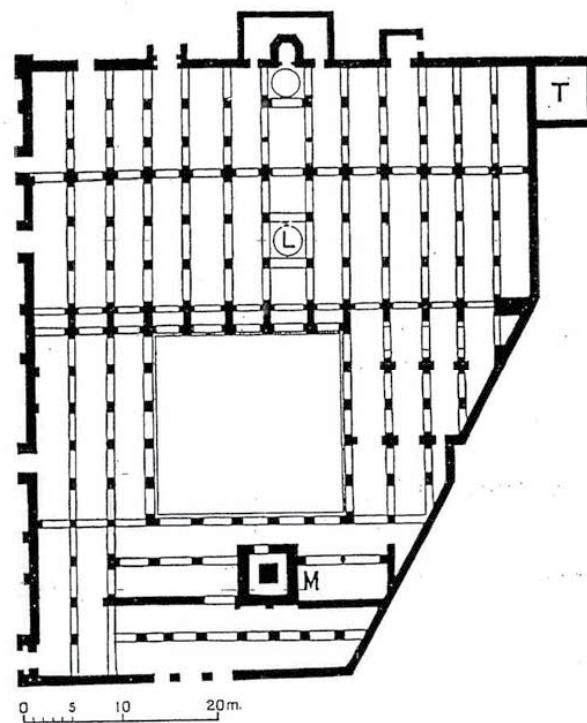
جامع ندرومة، مسقط أفقى، عن:
